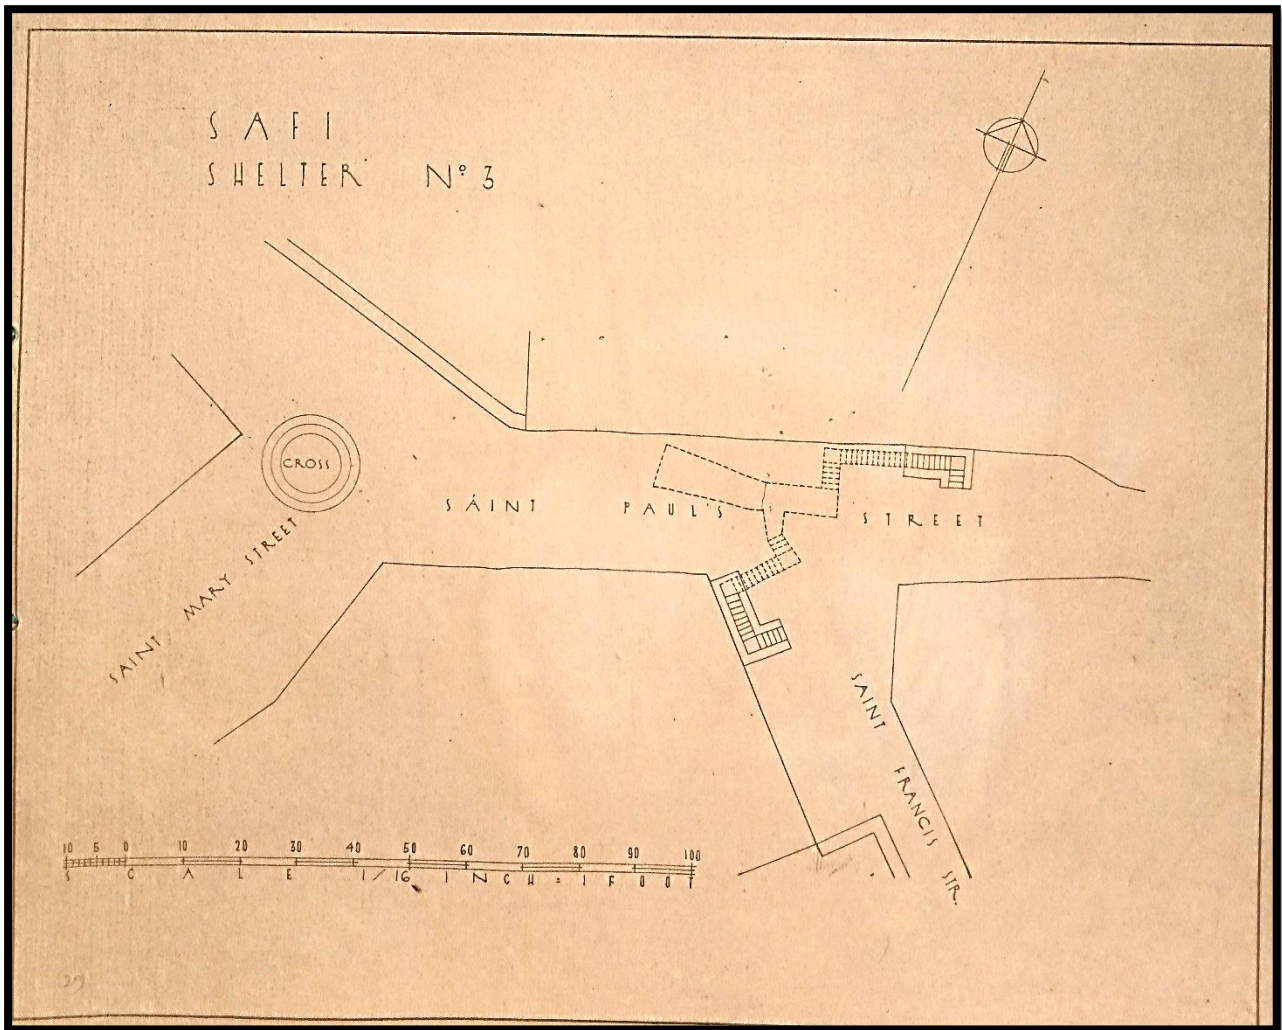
Planta do Abrigo nº3 "Saint Mary Street – Saint Paul's Street* – Saint Francis Str."
